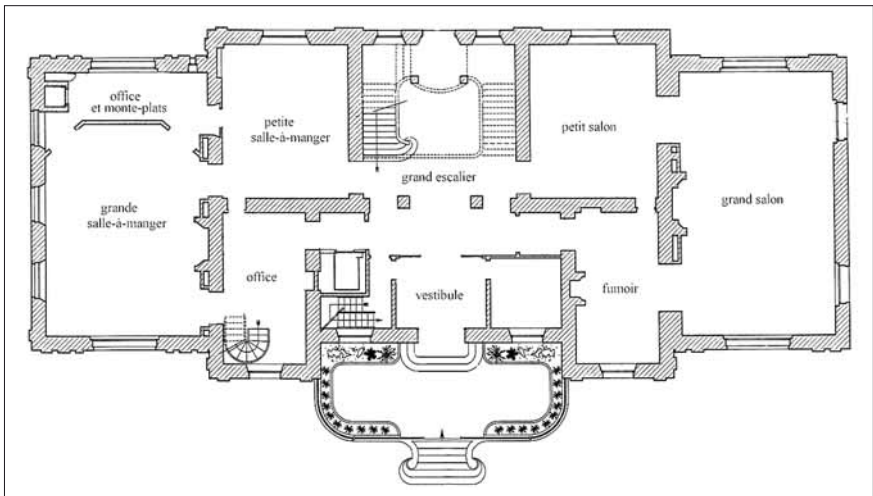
Plan du rez-de-chaussée du château actuel d'après plan DAUF, ville de Saint-Malo
